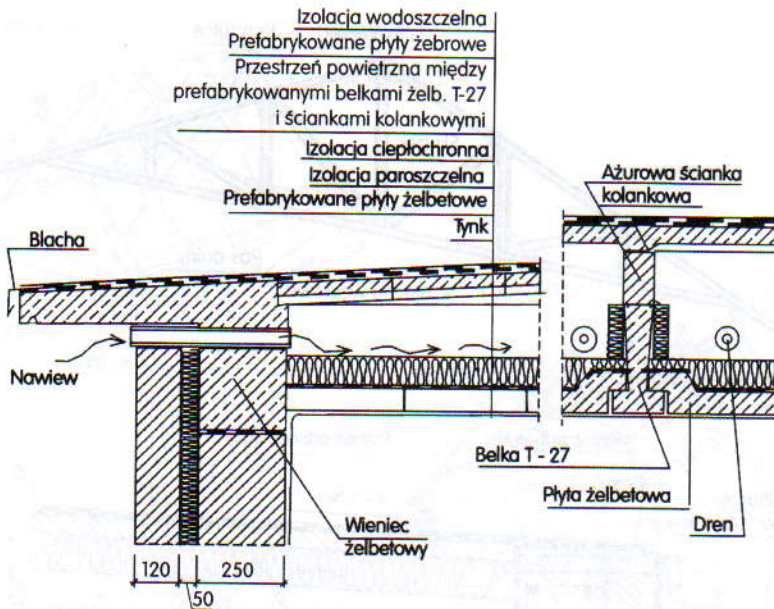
Przekrój poprzeczny stropodachu pełnego [6]
